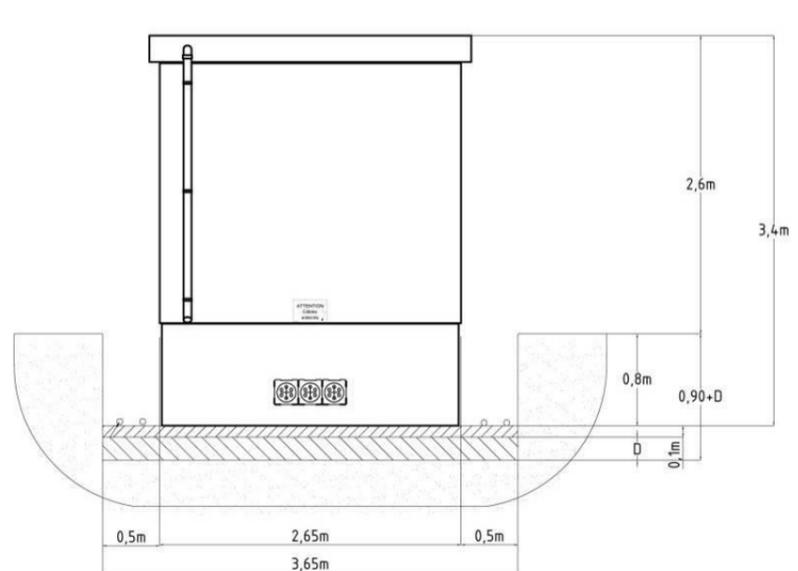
Plan de façade d'un poste de livraison (vue de profil)
